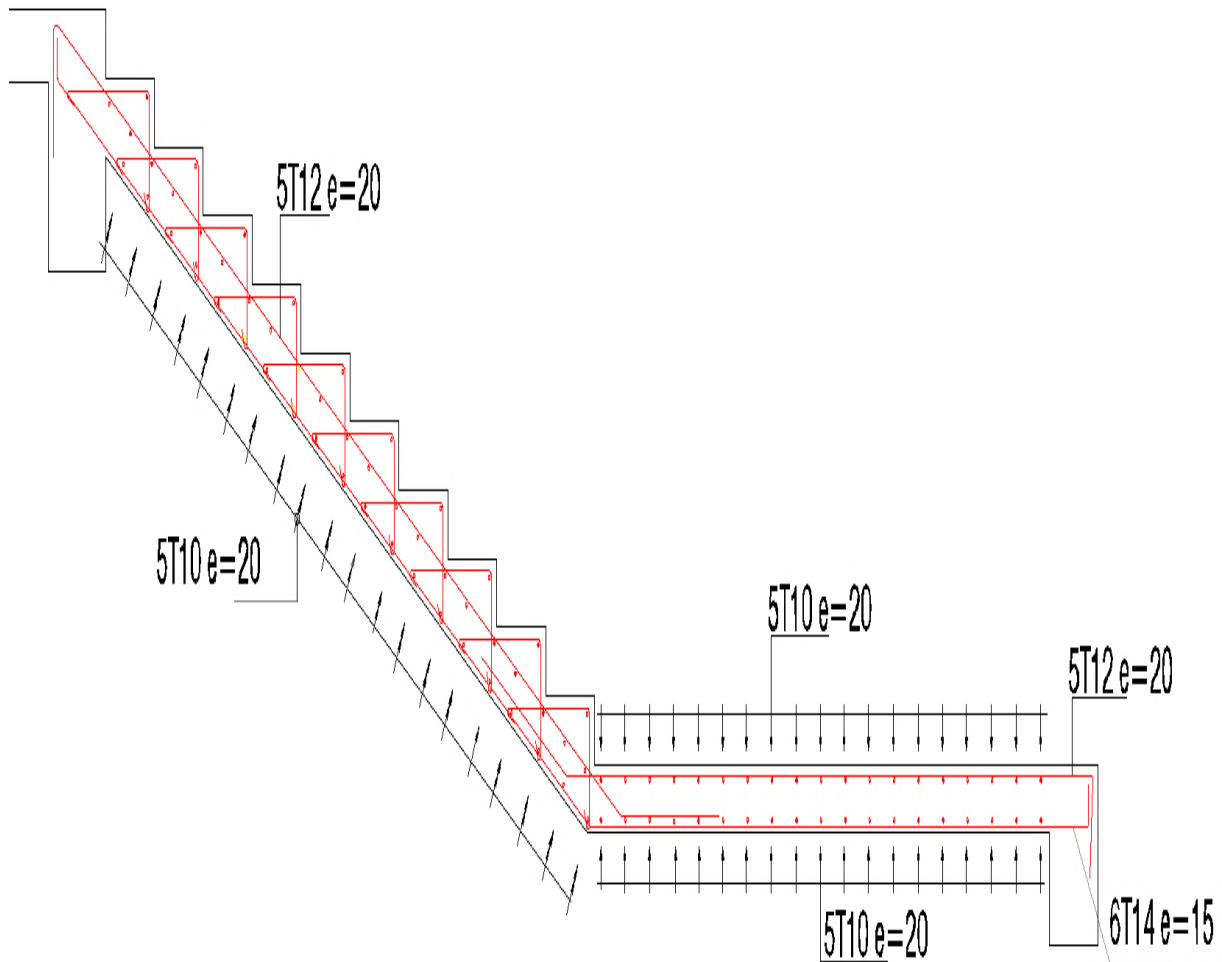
Schéma de ferrailage de l'escalier d'entrée
